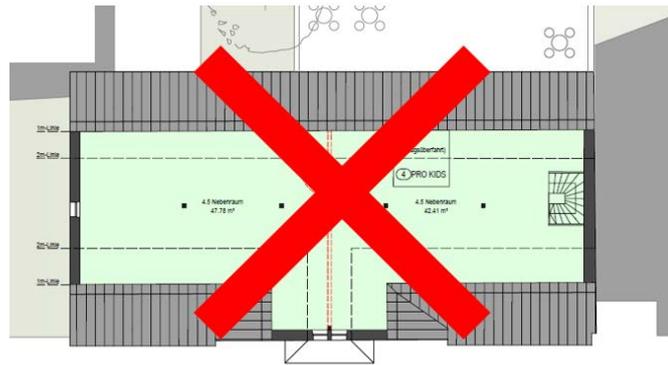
Grundriss des Dachgeschosses der Katharinenstraße 2b
